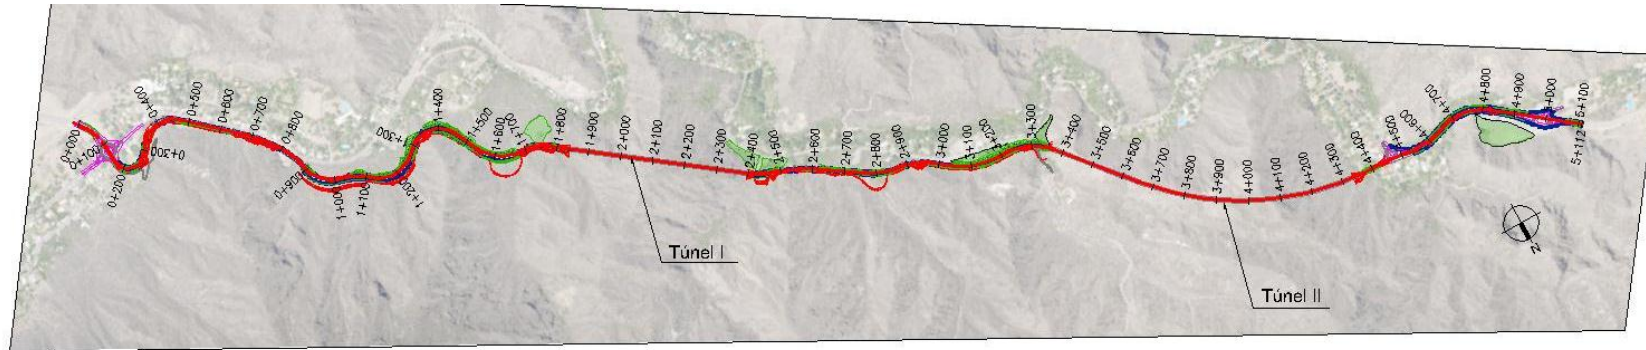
Planialtimetría General de Proyecto Ejecutivo.
